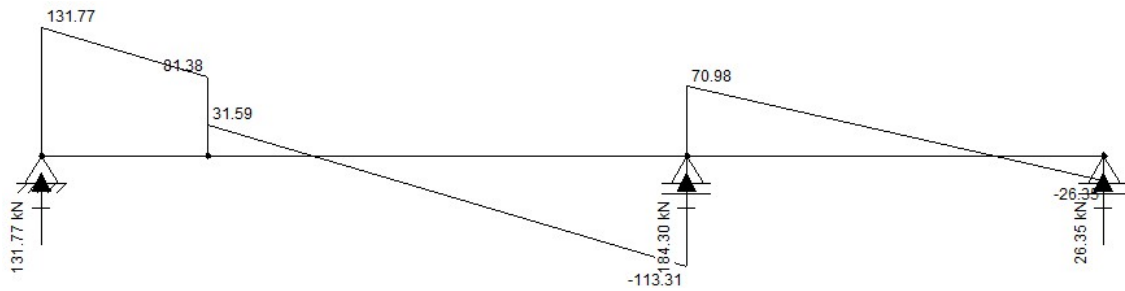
Reações de apoio da viga V4 do teto do 1º pavimento
